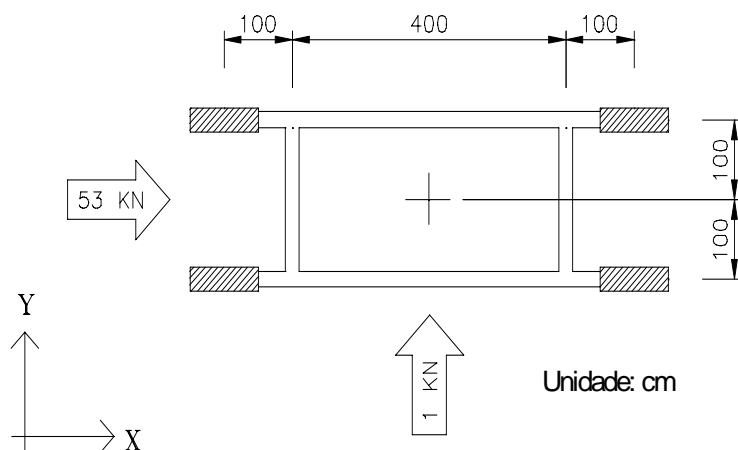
Estrutura com ligação viga-viga nas proximidades de pilares - caso 01
